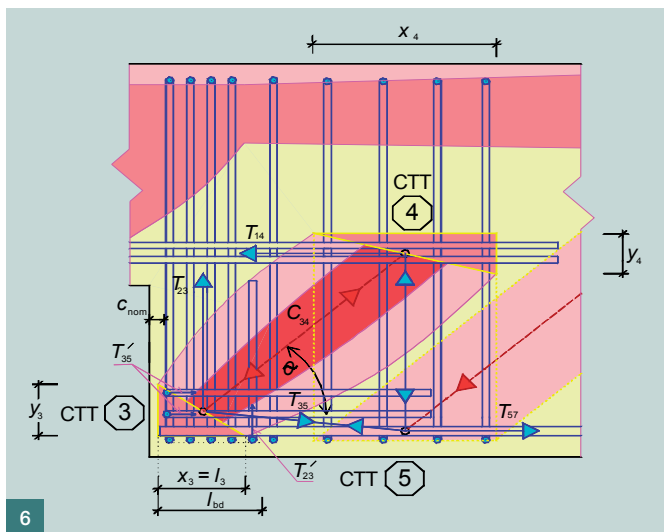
Vyztužení pro návrhový model A a B ■ Fig. 4 Detailing of reinforcement for design using STMs A and B
